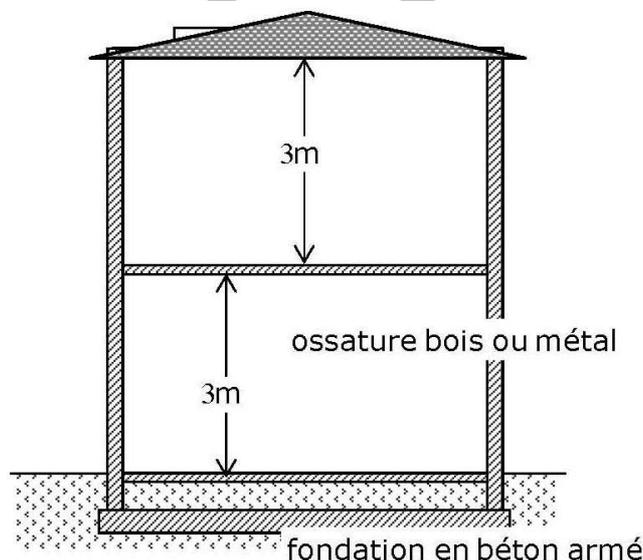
Exemple d'un bâtiment de type 5 (à ossature bois) ou de type 6 (à ossature métallique) : maison individuelle R+1
